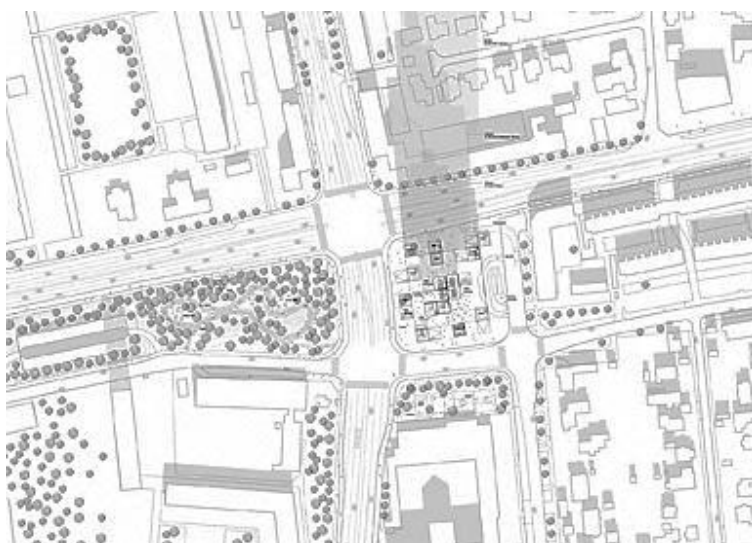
Edifício Sky Village, MVRDV, planta de implantação
